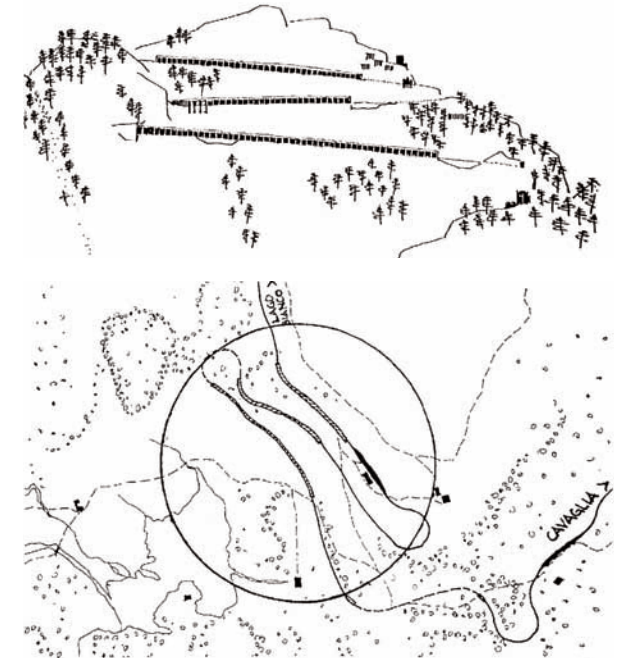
Ansicht und Grundriss der Bahntrasse (ALDER, 1981, 39)
